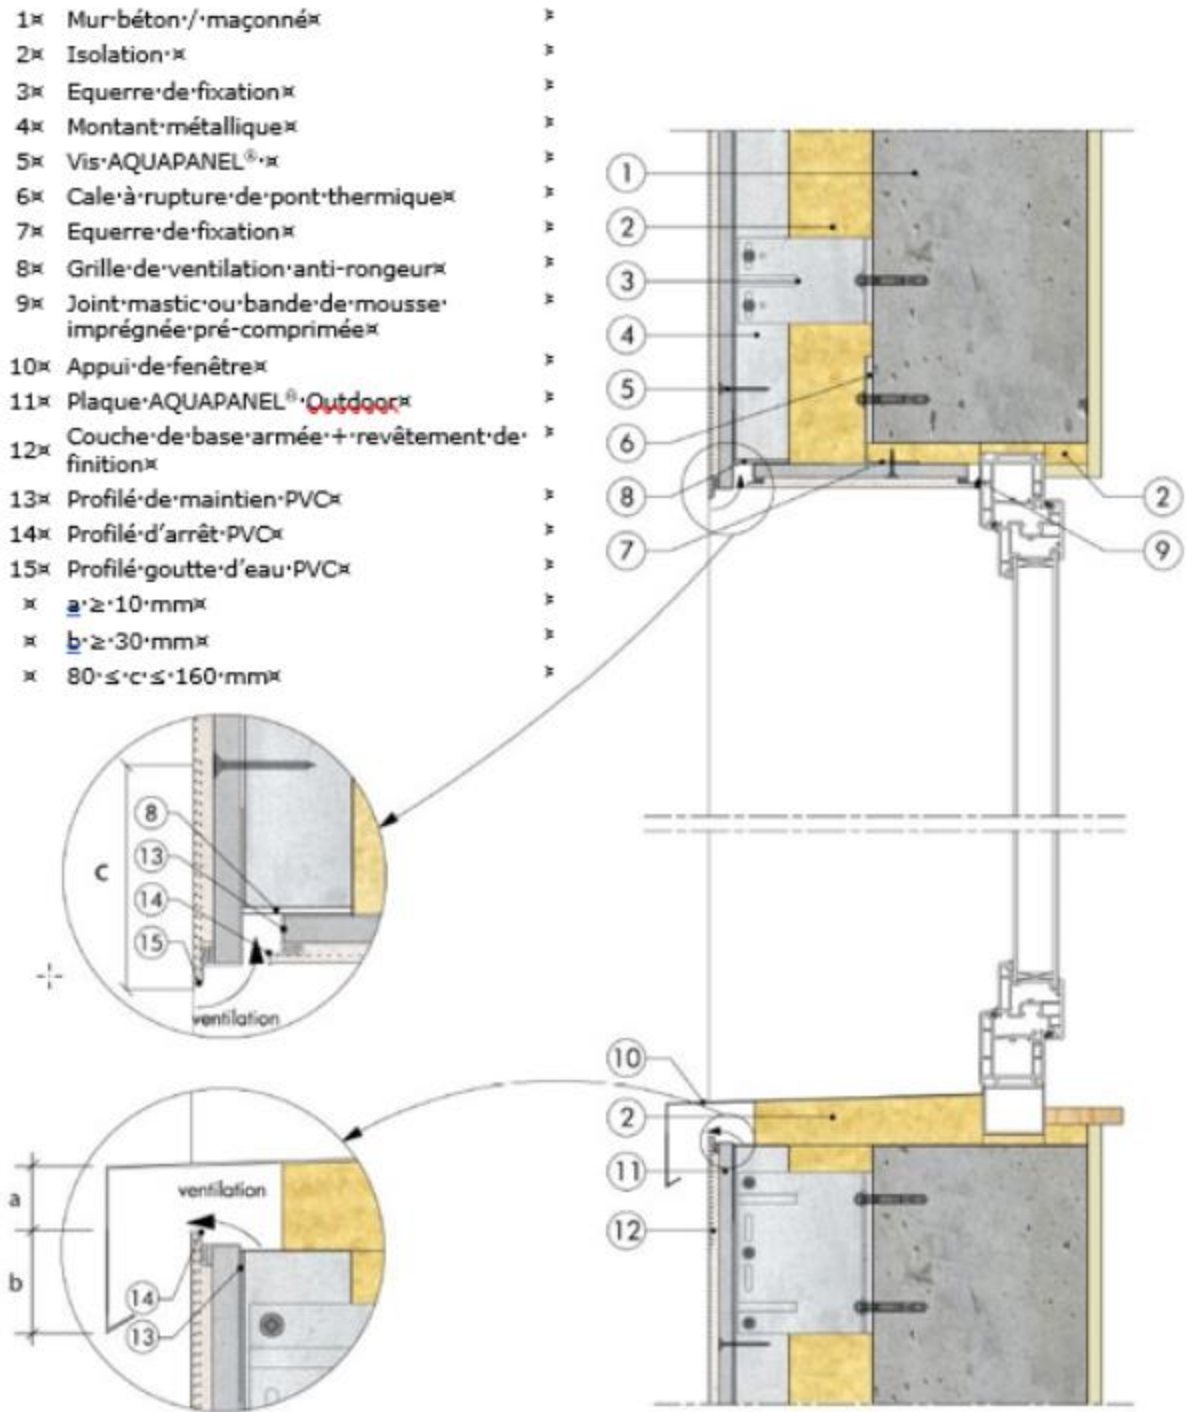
Traitement en linteau et en appui de fenêtre - Coupe verticale sur ossature métallique
